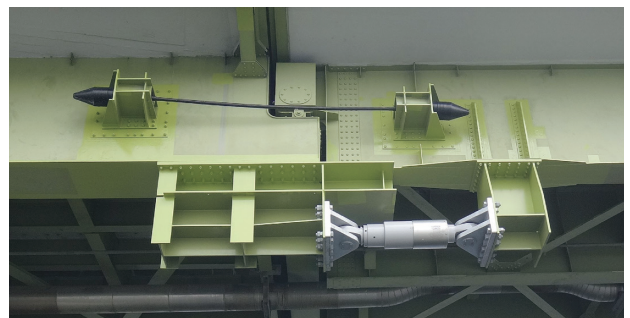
P10橋脚 ゲルバー部の粘性ダンパー
